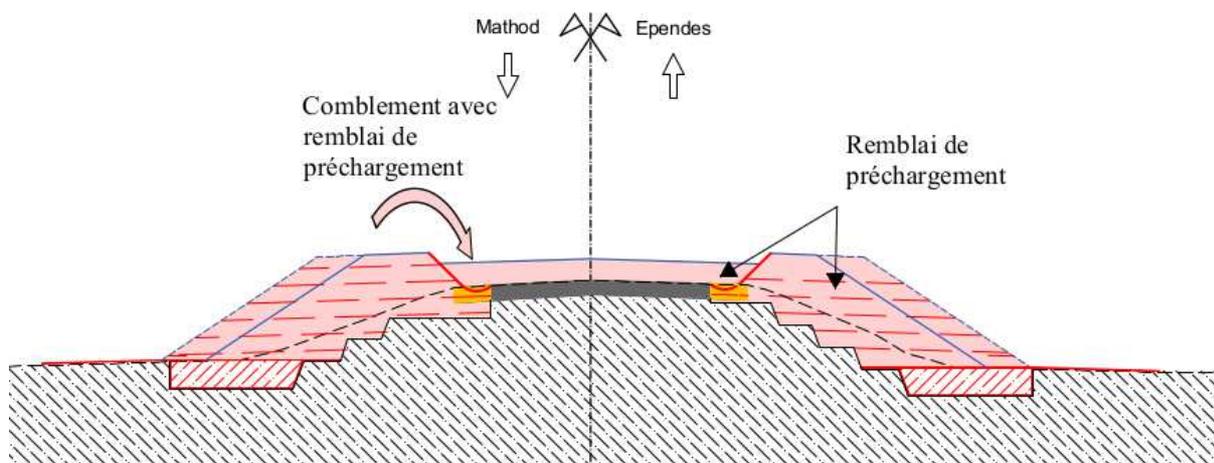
Coupe sur rampe d'accès du pont sur la Thielle avec remblais de préchargement (route fermée)
